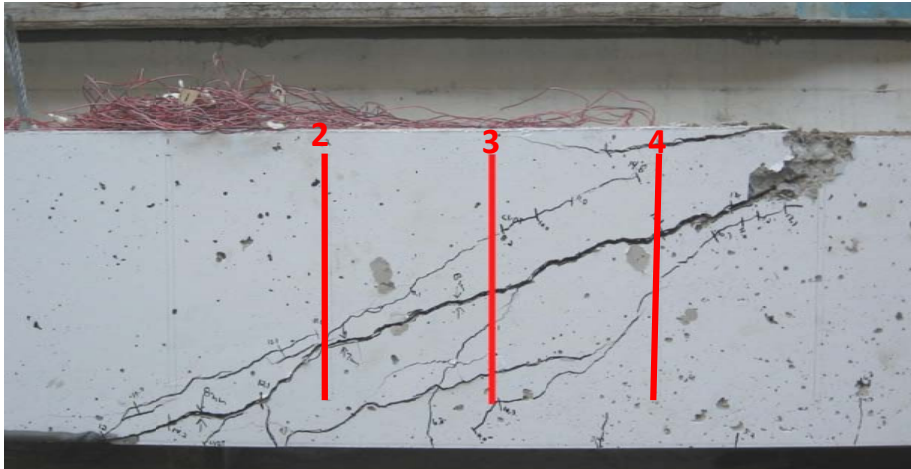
Position des barres de renforcement #2,3 et 4 de la dalle 1Ba, face sud
